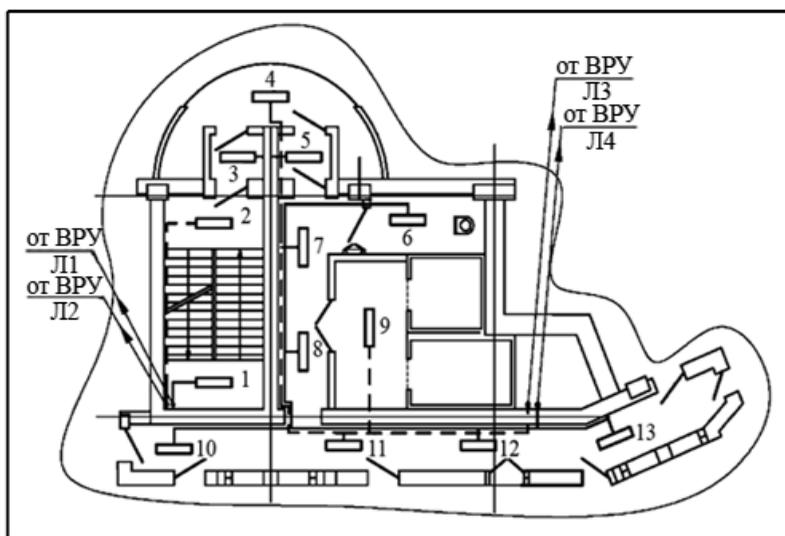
План размещения и схема питания светильников для освещения общедомовых помещений и лестничных клеток:
